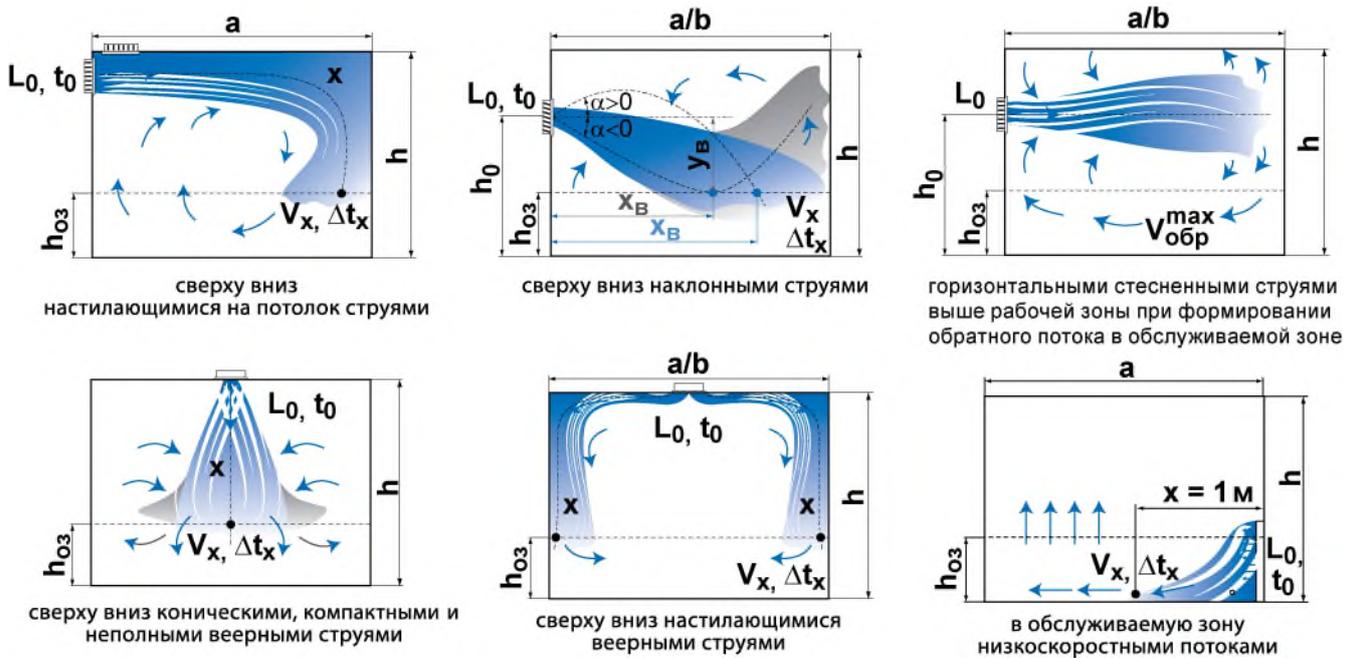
Основные схемы подачи приточного воздуха
